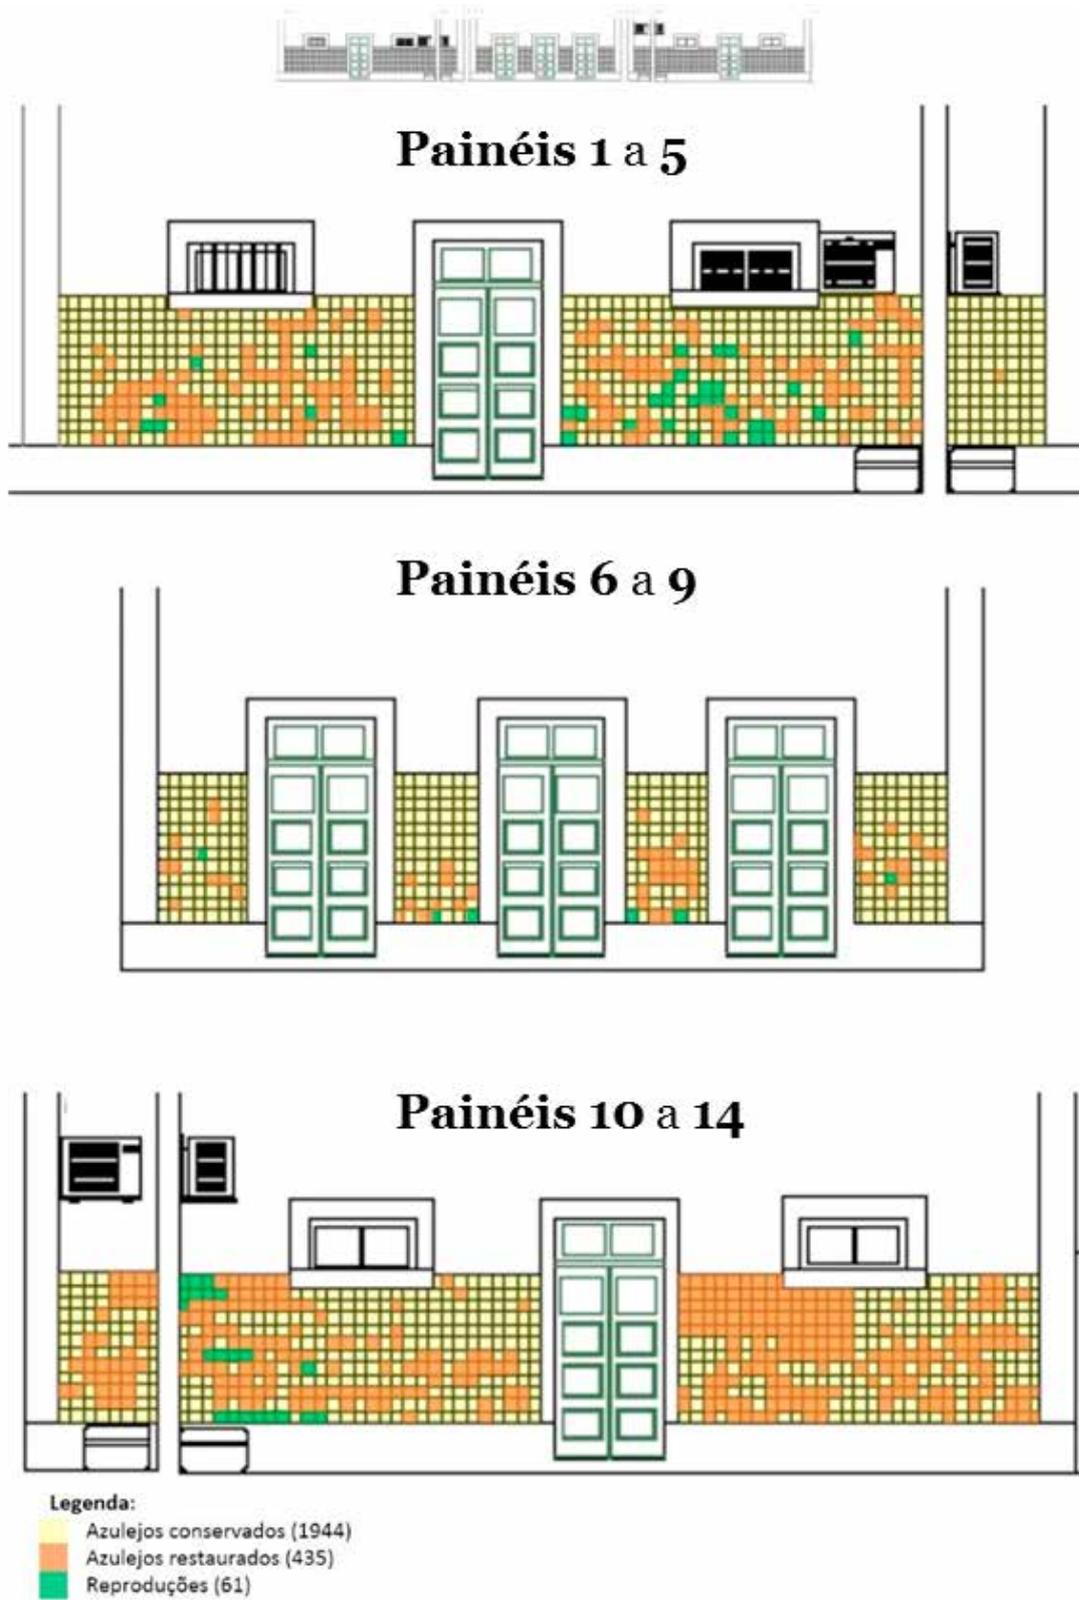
· Fachada Poente. Painéis azulejares do n.º 1 ao n.º 14.
